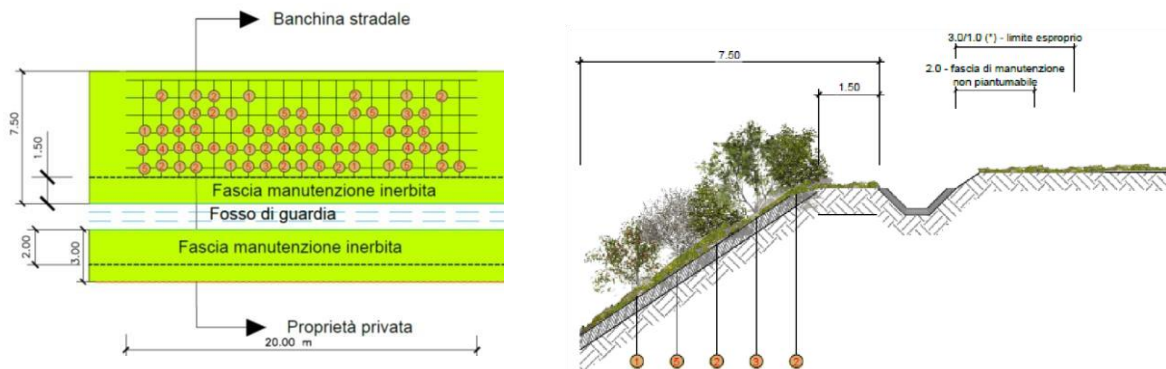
Griglia e Prospetto modulo PI-TR SCA 2
